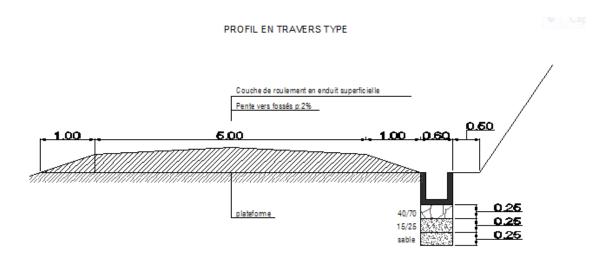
PROFIL EN TRAVERS TYPE PROPOSÉ POUR LA ROUTE DE RAMENA, AVEC EXÉCUTION DRAIN
